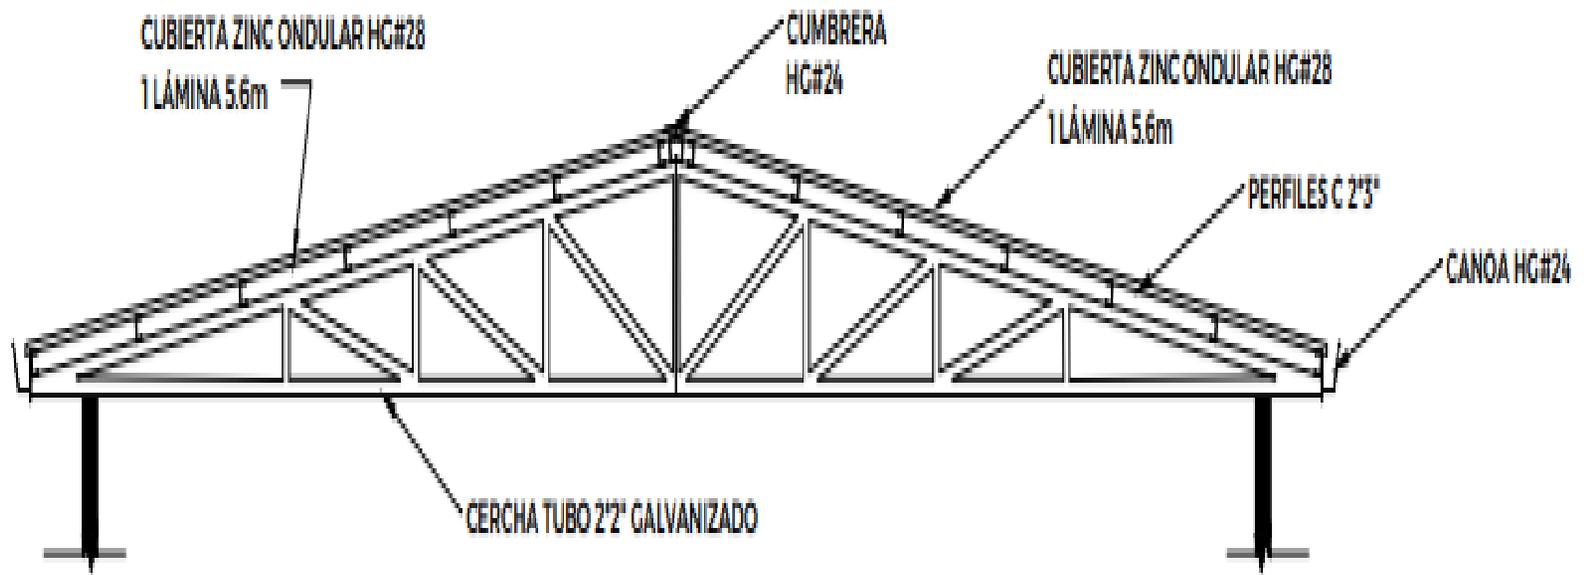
Planta de techos 2 aguas - Sistema constructivo Prefabricado- lamina prefabricada
